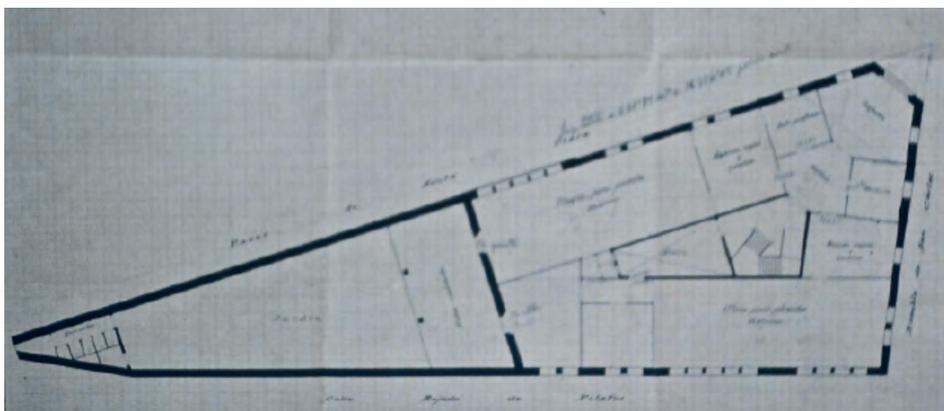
Propuesta de Escuelas Públicas. Planta baja, Josep M. Pujol de Barberà. A.H.C.T.
